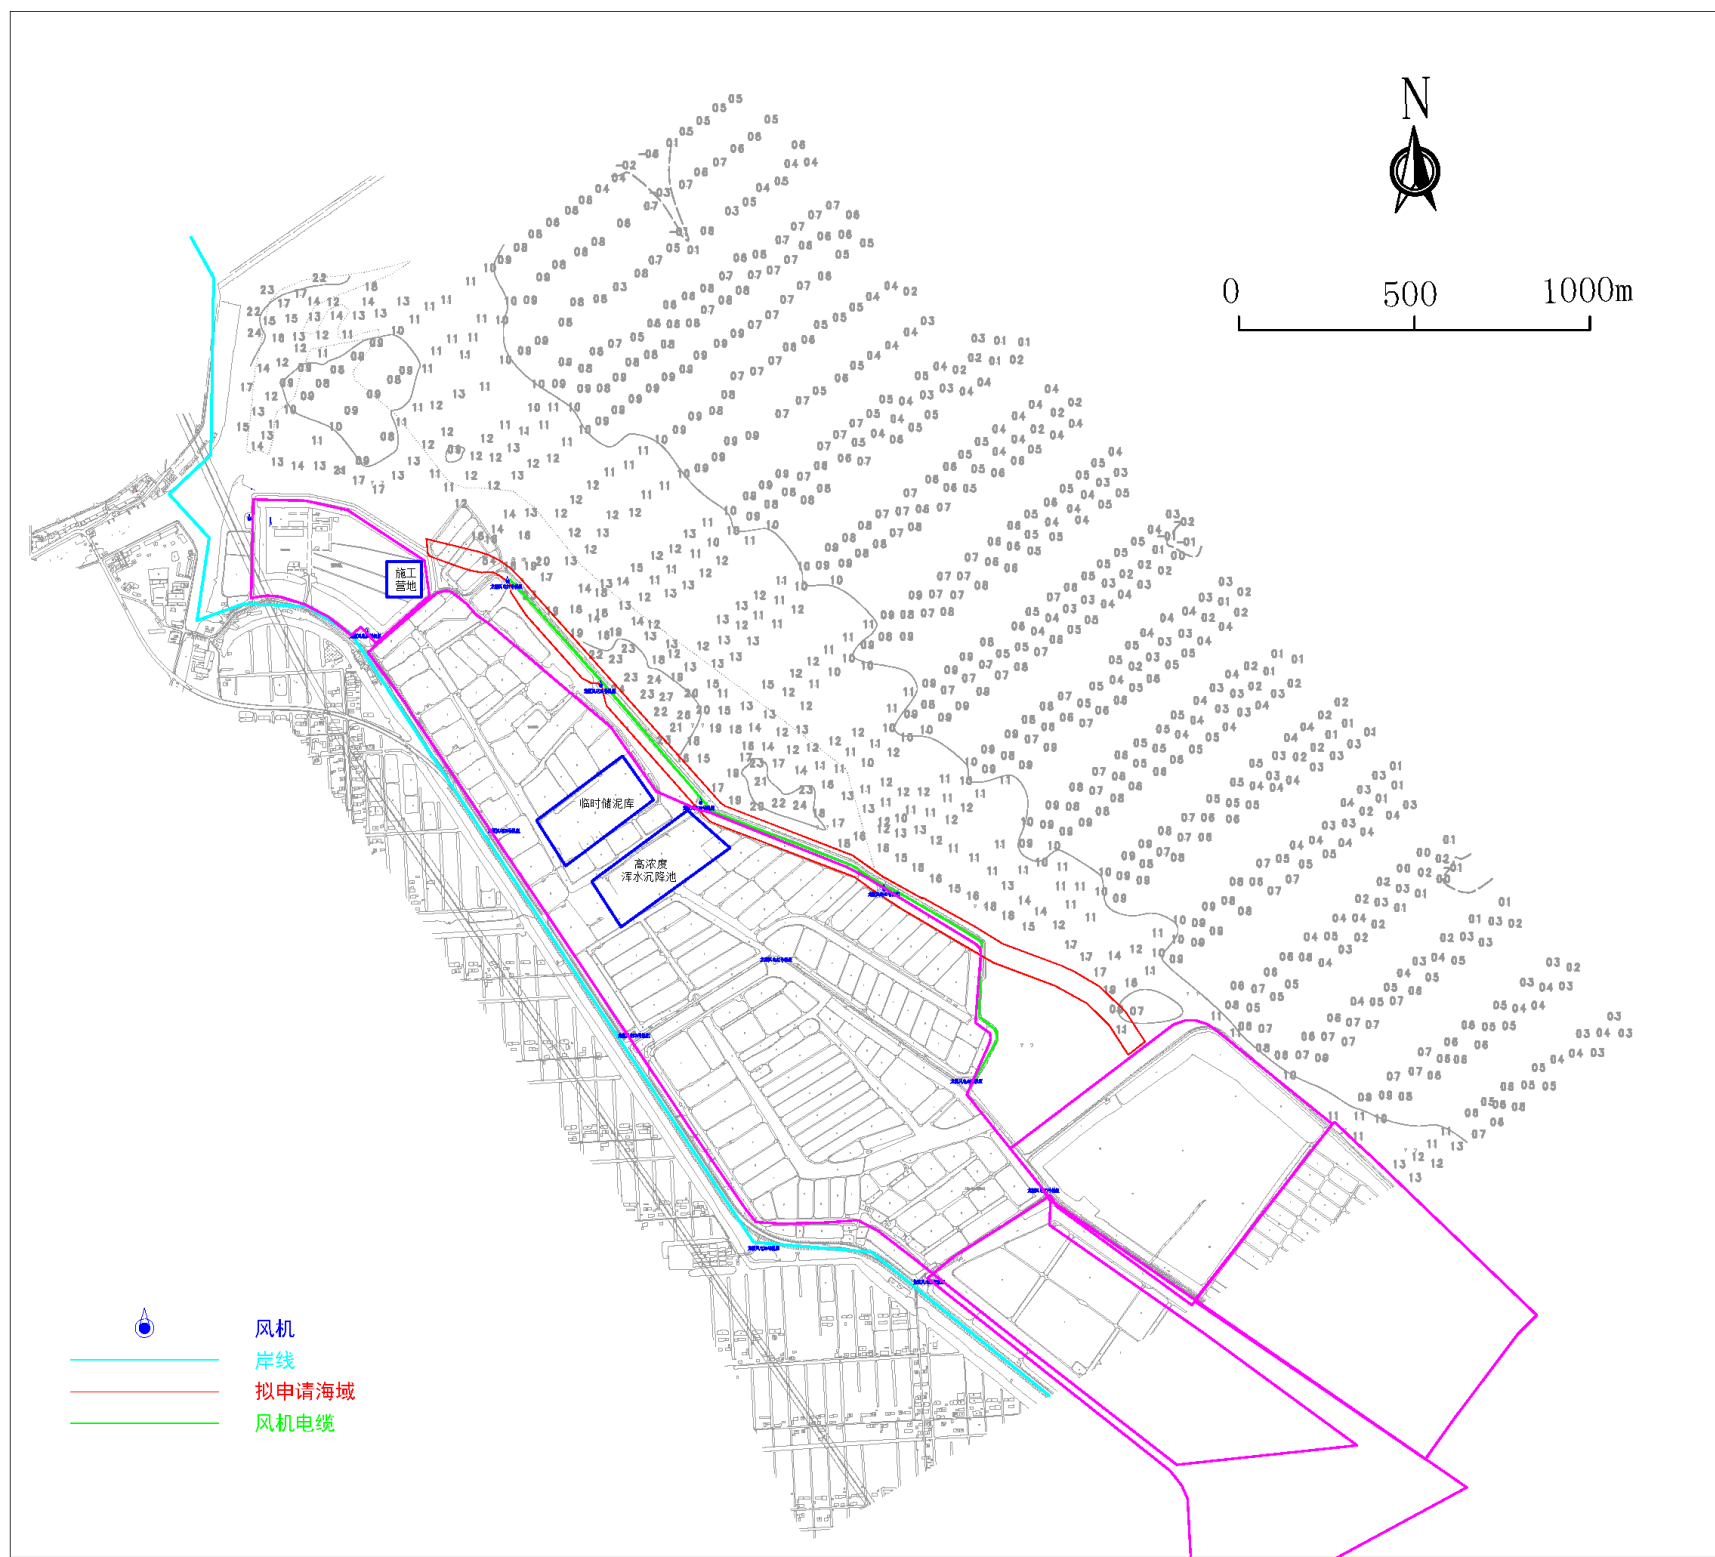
启东市蒿枝港南部海岸防护修复工程平面布置图
